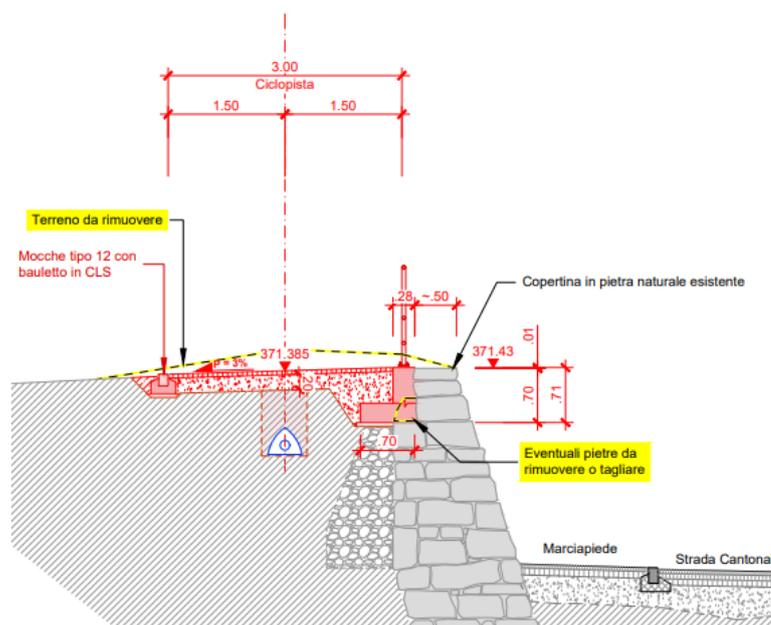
Sezione tipo su nuovo muro di sostegno (Sez. tipo B).
